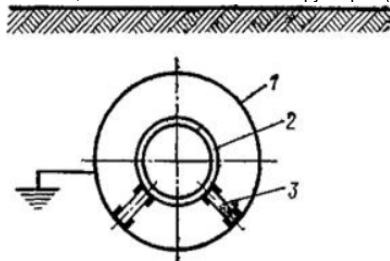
Схема размещения трубопровода в металлическом футляре:
